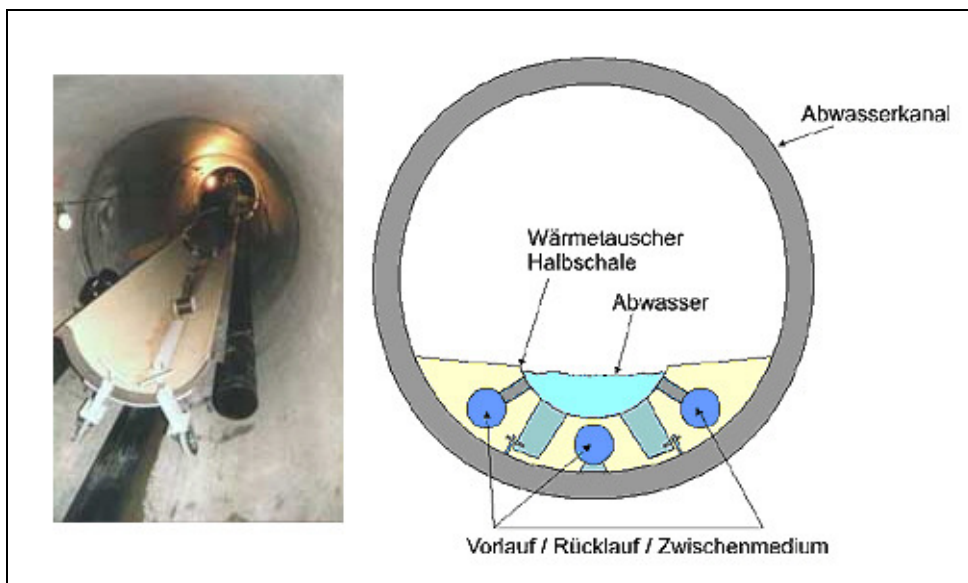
Einbau des Wärmetauschers in einen vorhandenen Kanal (nach santec-gmbh.de)
